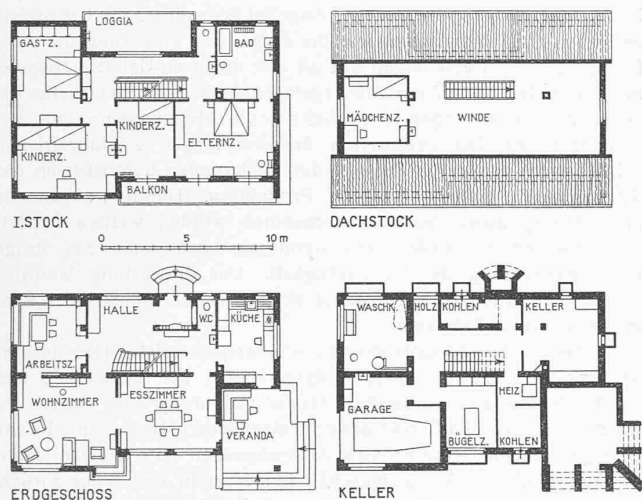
Haus Stiefel. Arch. Albert Kölla, Wädenswil. — Grundrisse 1 : 400.
